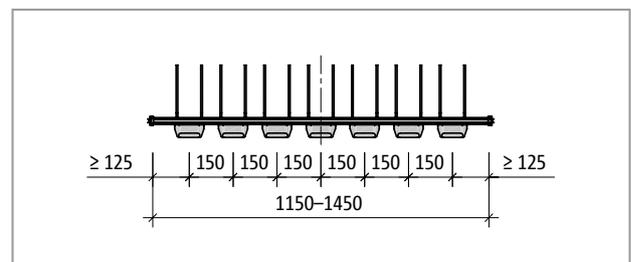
Schöck Tronsole® Typ T-V7-...-L1150 bis L1450: Produktgrundriss
